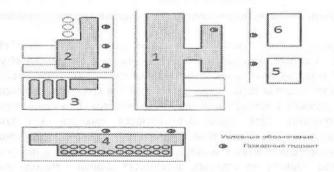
План размещения зданий и сооружений (наружных установок) химического цеха ЗОС
